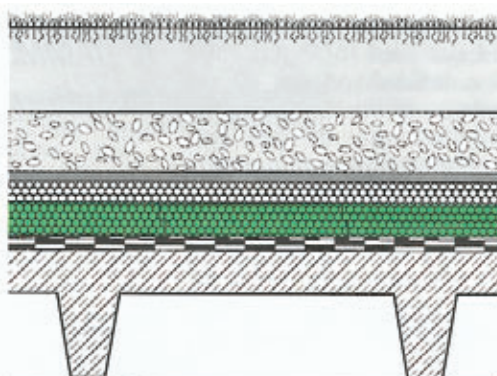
Schichtaufbau des Gründachs mit funktionstüchtiger Sickerschicht beim Kurmittelhaus Bad Füssing, G 2.
